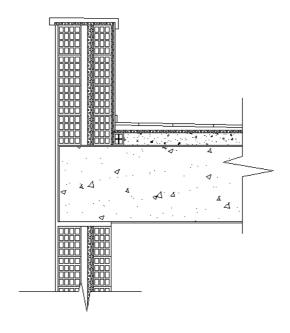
Encuentro de fachada caravista con cubierta plana. Fuente: Edición propia
